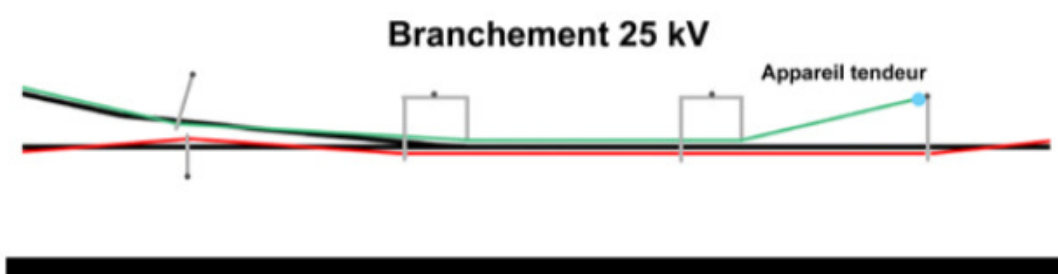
Plan d'un branchement simple (J. Cuynet).
